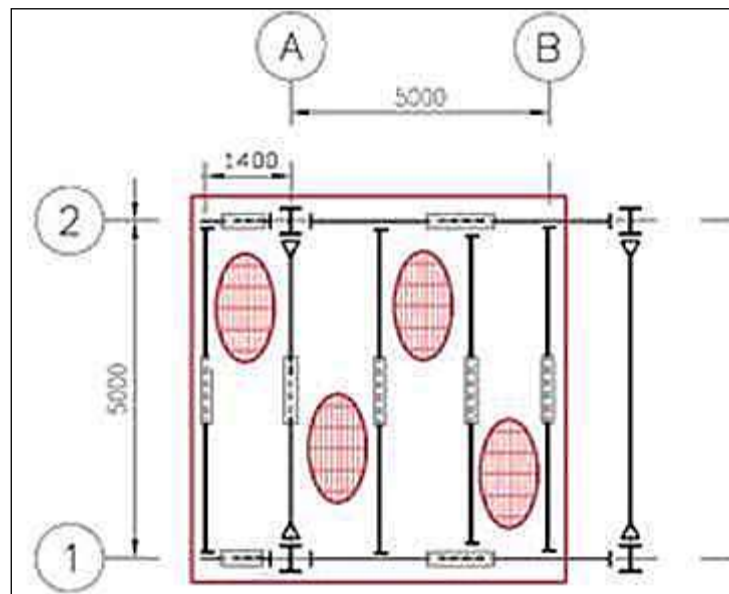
Detalle de Plataforma - Vista de Planta – PSLCV
